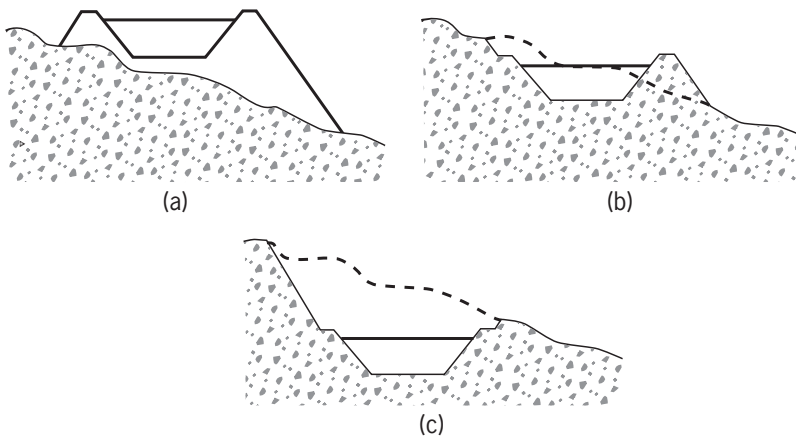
Depósito elevado (a); mixto o a media ladera (b); y en trinchera o desmonte (c). Disposición (a) y (b) son presas, y (c) balsa.
